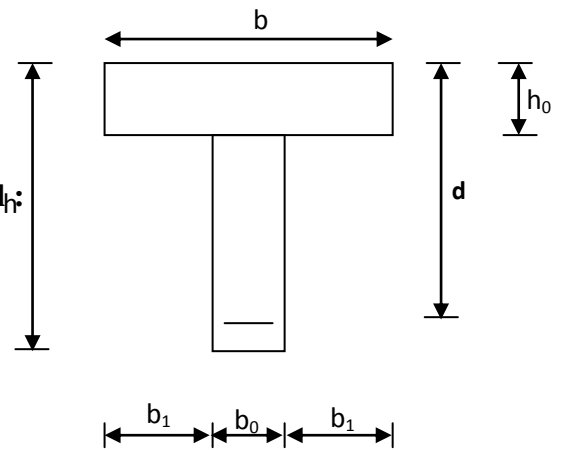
Section de calcul de la poutrelle après coulage de la dalle de compression
